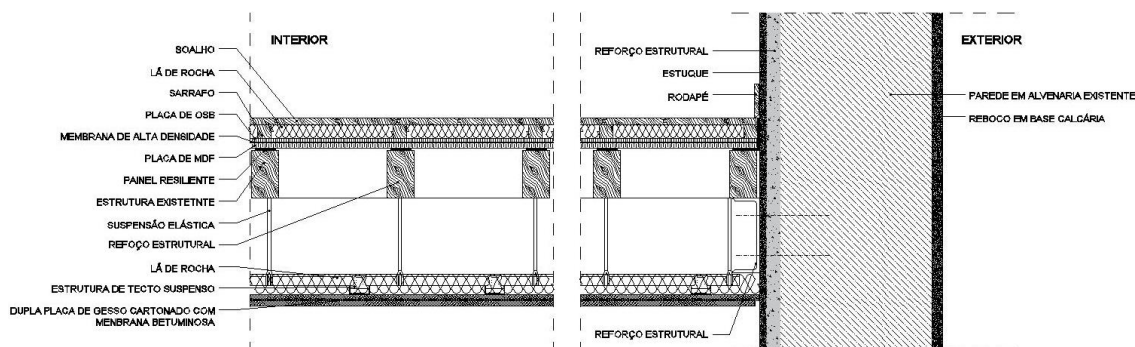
Pormenor Laje. (Ilustração nossa, 2019).
